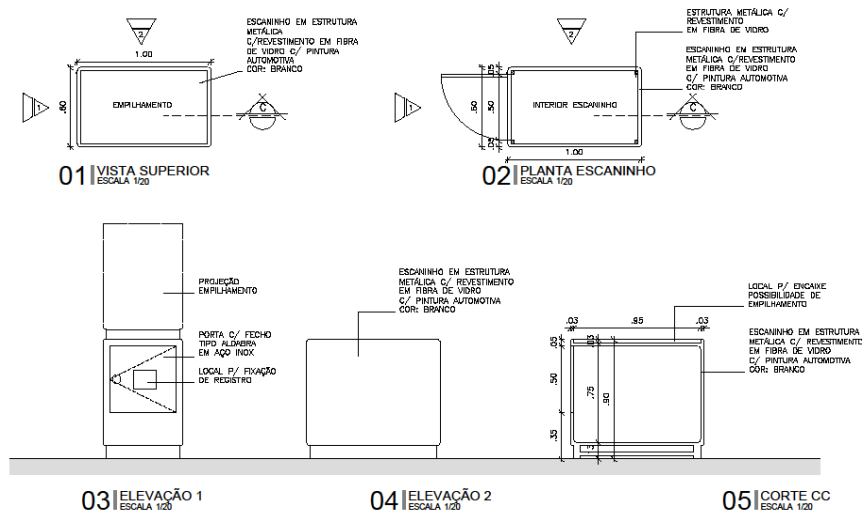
Vistas dos barracões (pergolados) com deck e escaninhos. Fonte: COPROJ-SEINF.
